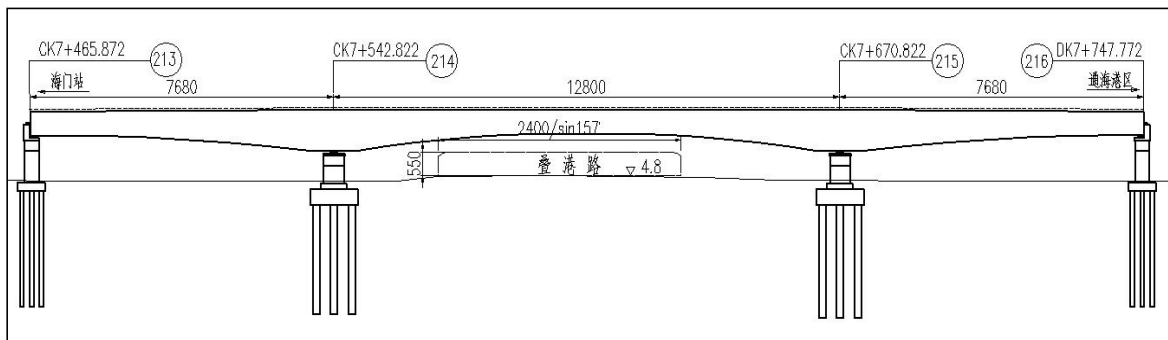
跨叠港路桥梁立面图（单位：cm）
